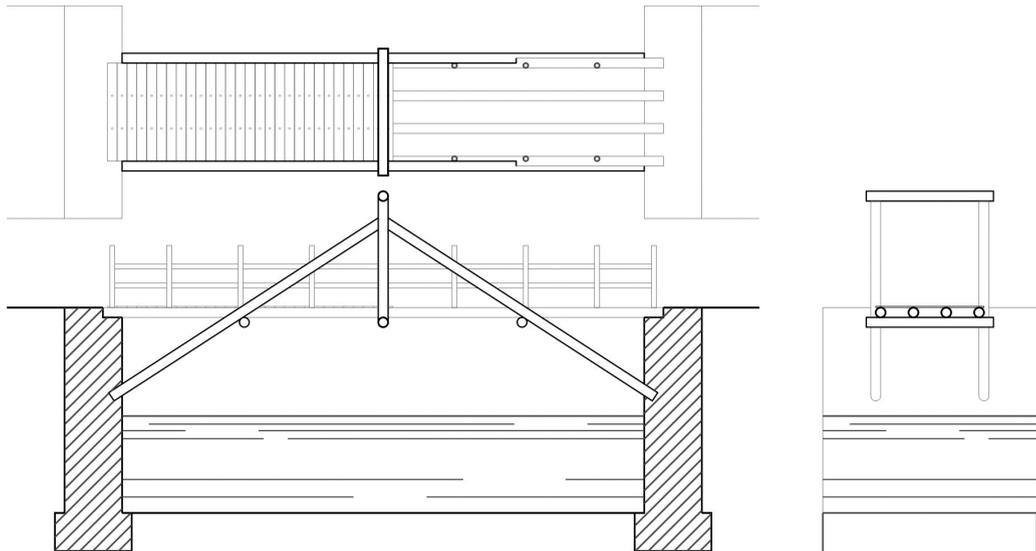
Puente de madera sobre estribos de cantería sobre el río Guali, proyectado por Ignacio de Sala. Fuente: elaboración propia a partir del plano existente en el Archivo General de la Nación (Bogotá), Mapoteca 4, N.º 366-A, VC 552
